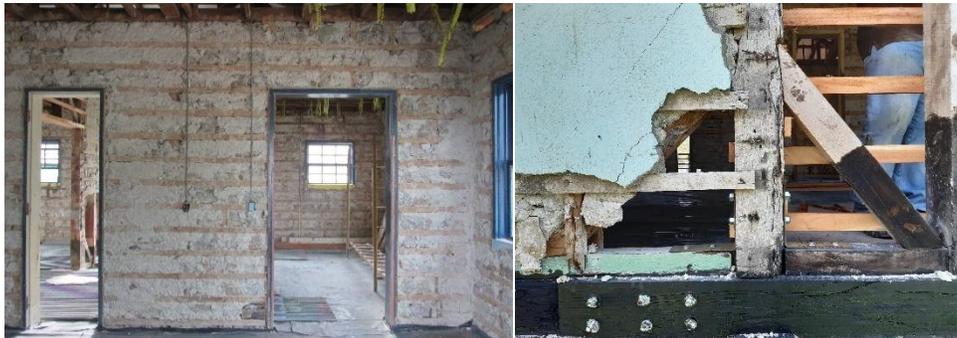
Paredes Antiguas de Taquezal de Piedra Azul y Mortero de Cal con Arena.
